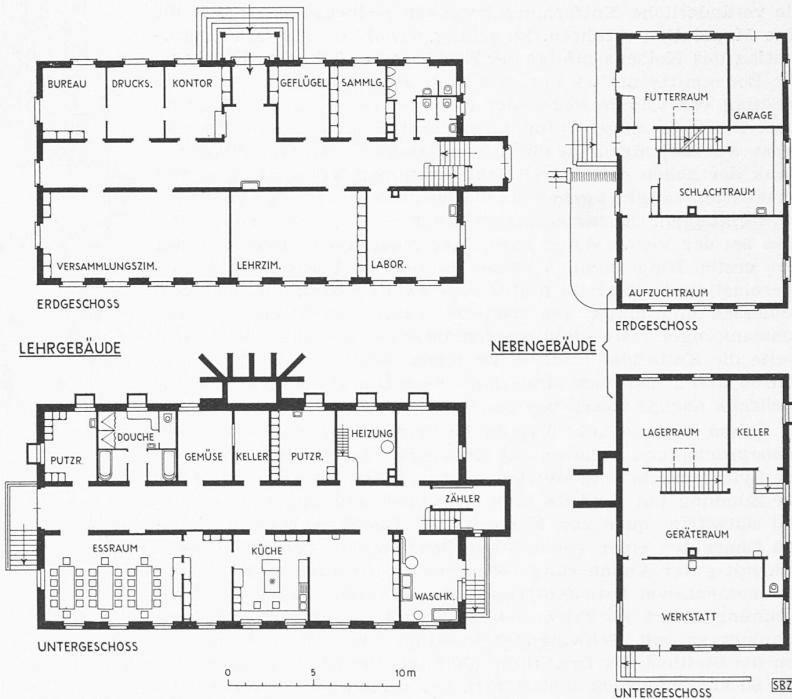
bis 27. Grundrisse 1:400 von Lehr- und Nebengebäude
